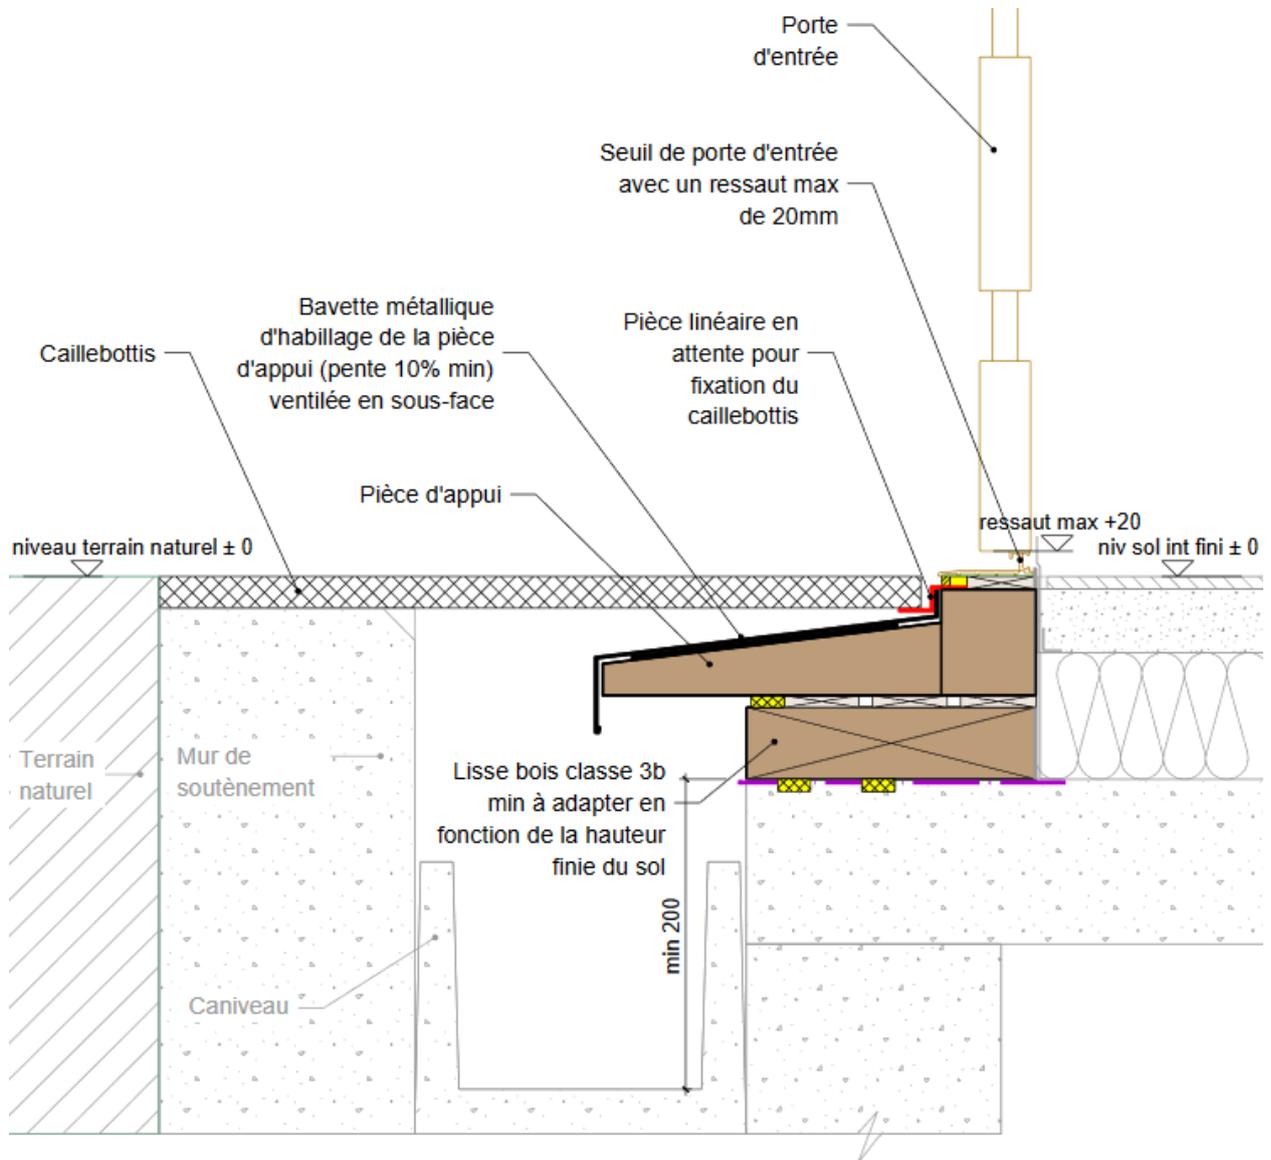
Exemple de conception d'un seuil de porte d'entrée au droit d'une porte d'entrée (coupe verticale)
